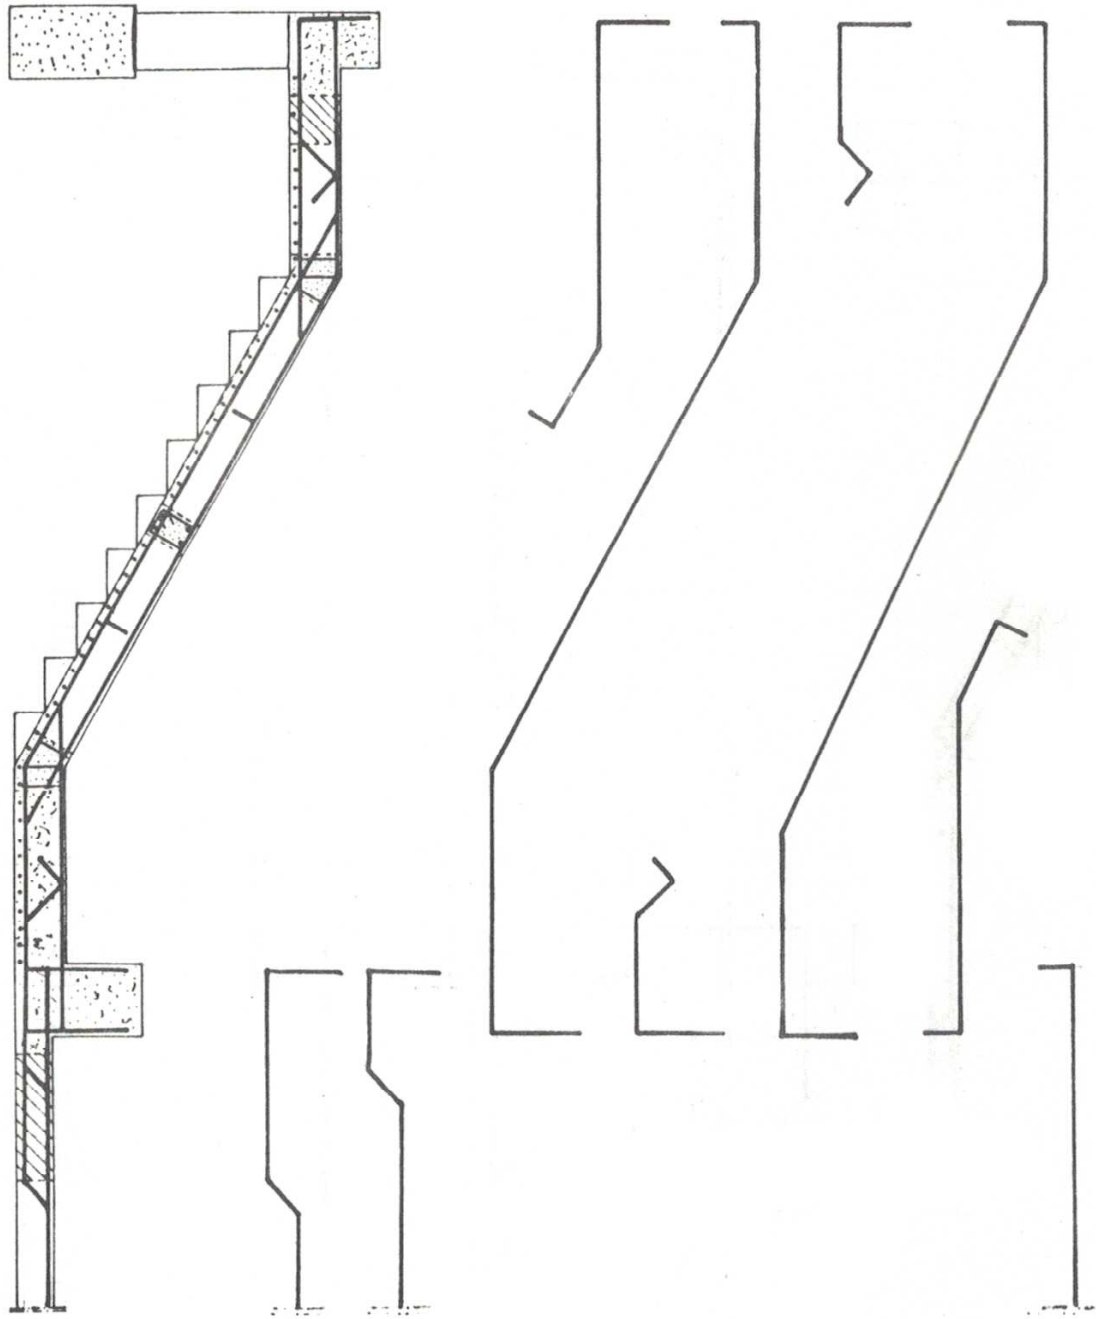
Disposizione delle armature dei travetti (rampa in discesa)
